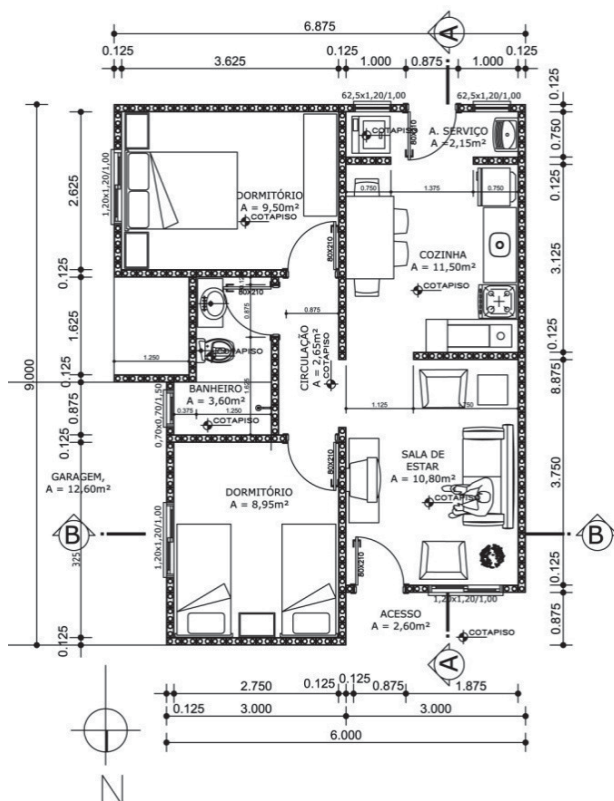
Planta baixa da habitação Fonte: Vaghetti et al.,2013).
